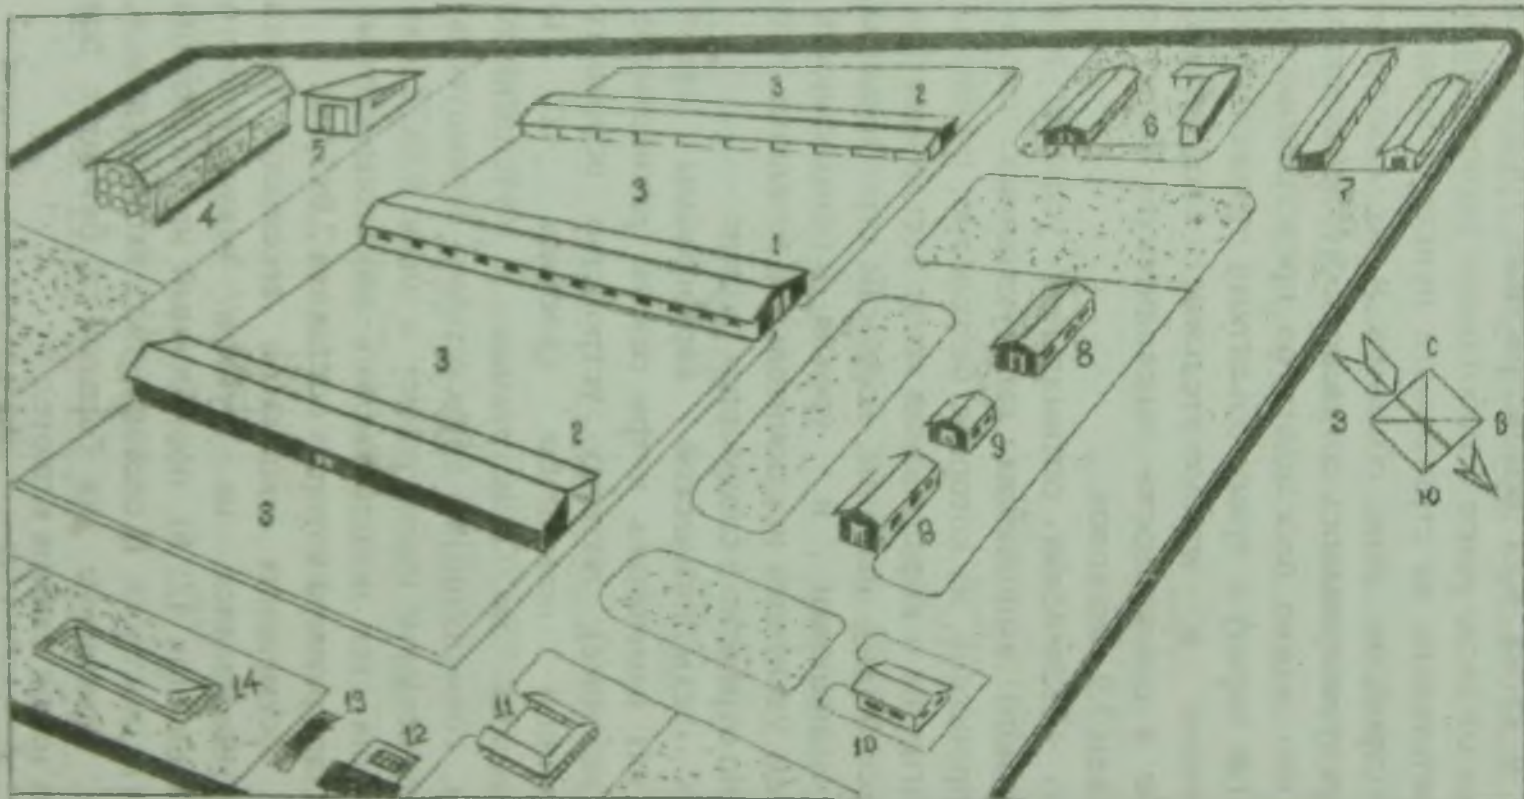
Овцеводческая ферма на 3,0 тыс. голов овец. 1 – основные производственные помещения; 2 – навес полуоткрытого типа; 3 – площадка; 4 – сенохранилище; 5 – кормоцех; 6 – пункт осеменения; 7 – изолятор; 8 – жилой дом; 9 – хлебопекарня; 10 – баня; 11 – стригальный пункт; 12 – дезбарьер; 13 – эстакада; 14 – купочная ванна.
